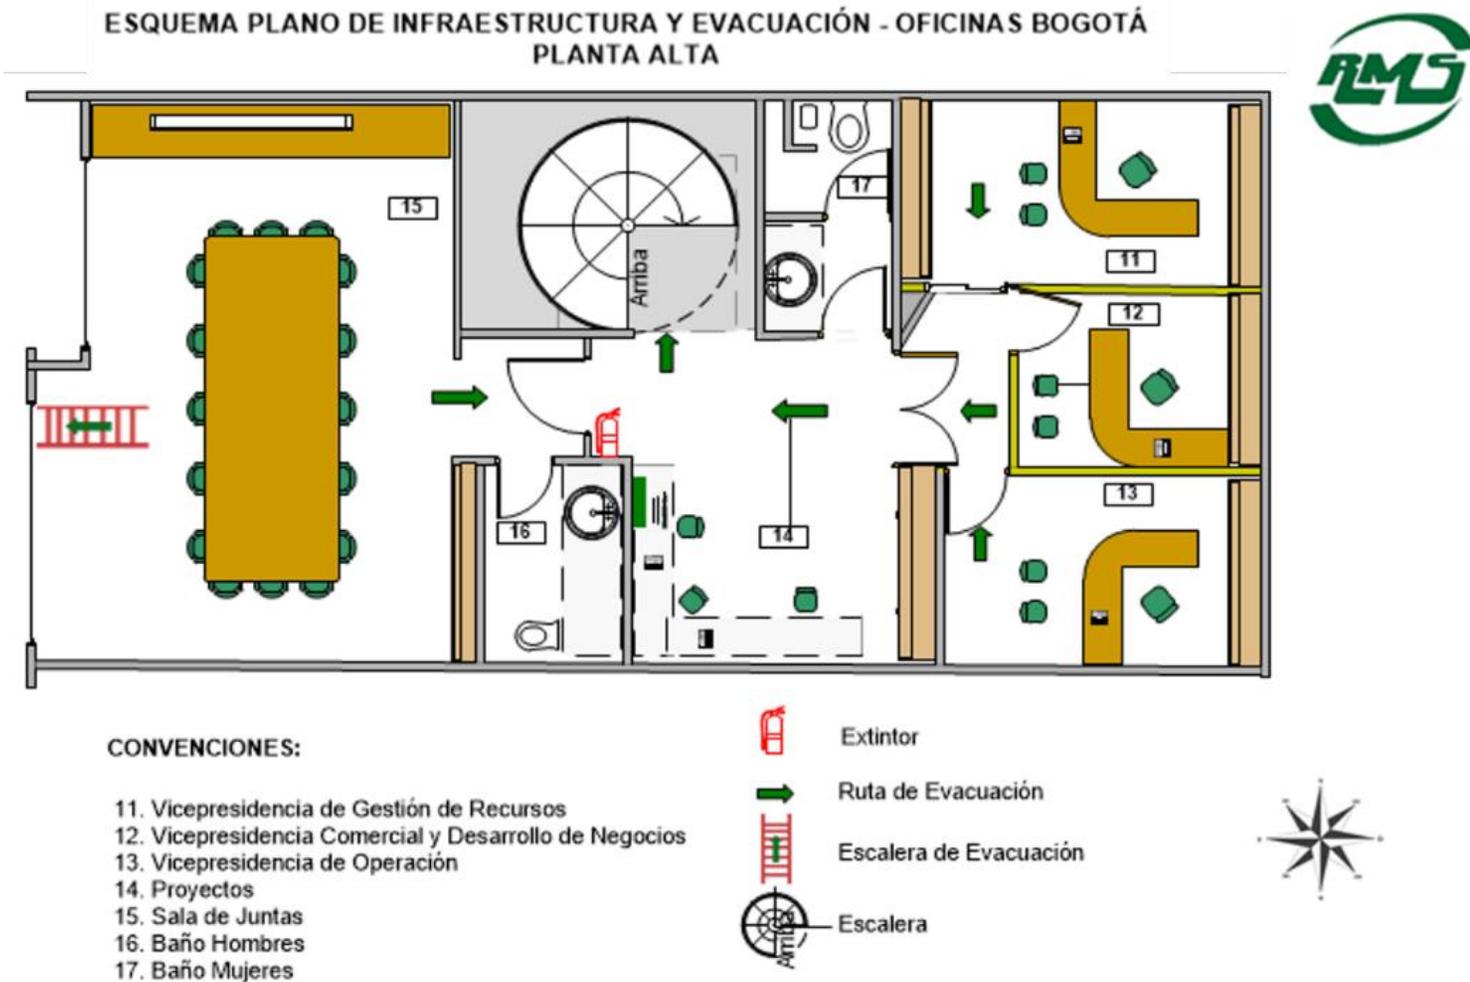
Planta Superior Infraestructura Oficinas Bogotá.
